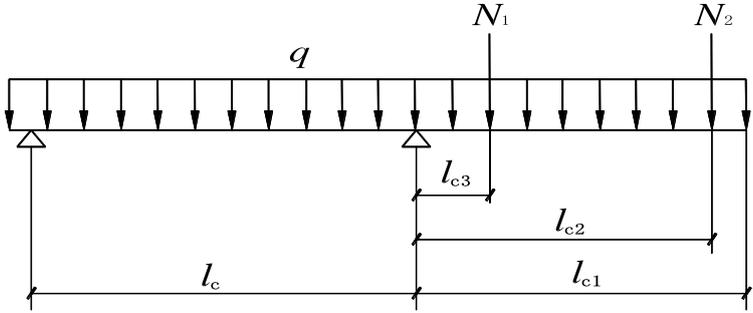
悬挑脚手架型钢悬挑梁计算简图
